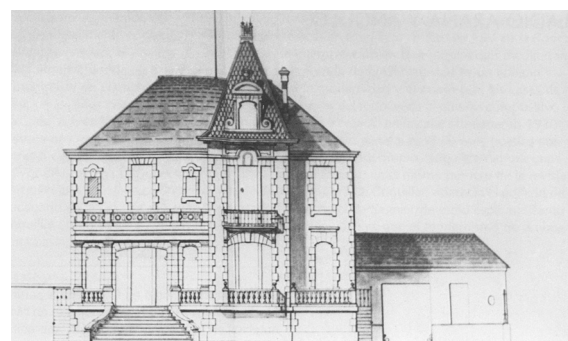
Puesta a escala. Alzado Villa Enriqueta Soler (Cartagena)
